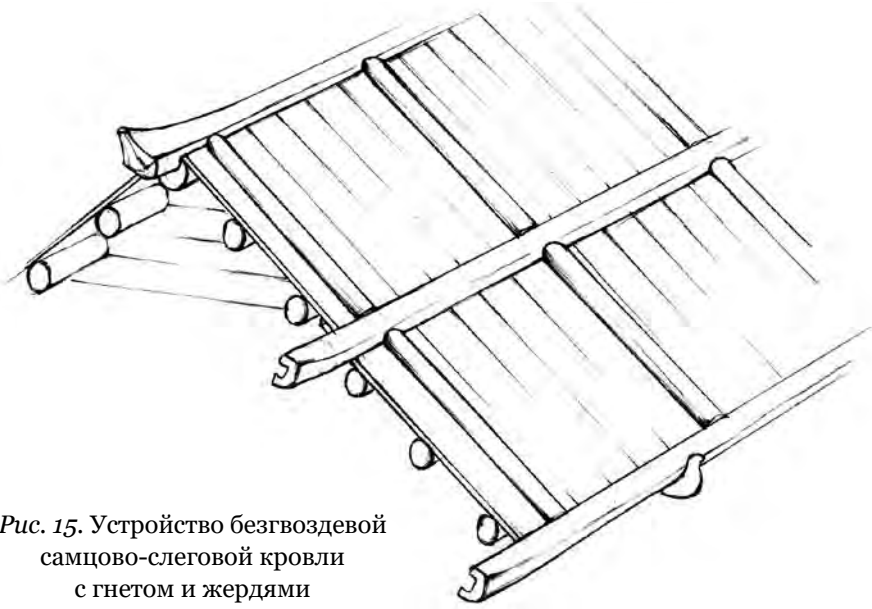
Устройство безгвоздевой самцово-слеговой кровли с гнетом и жердями
